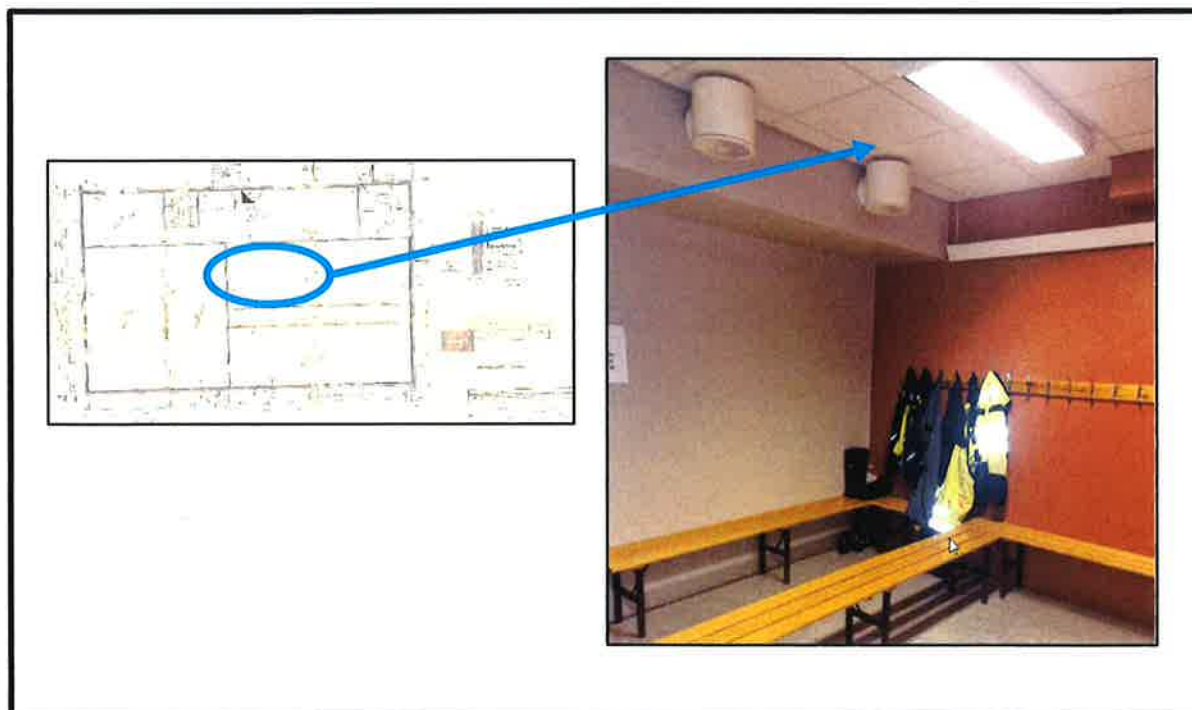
Tilstand betongdekker over kjelleretg, bassengdel
